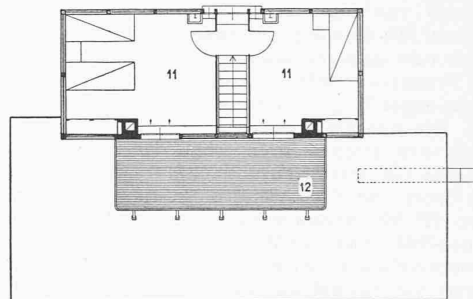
u. 3. Schnitt und Grundriss Obergeschoss, 1:200
